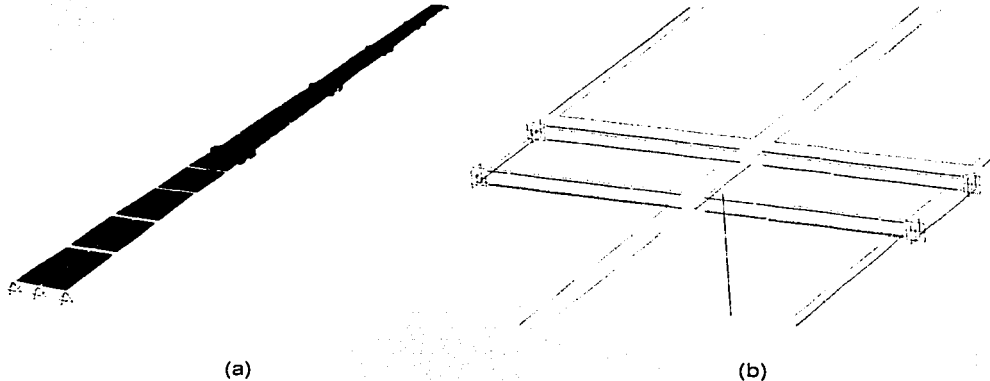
Modelación de la superestructura (a) Vista de los 5 tramos (b) Detalle del modelo donde se ubican los aisladores.
